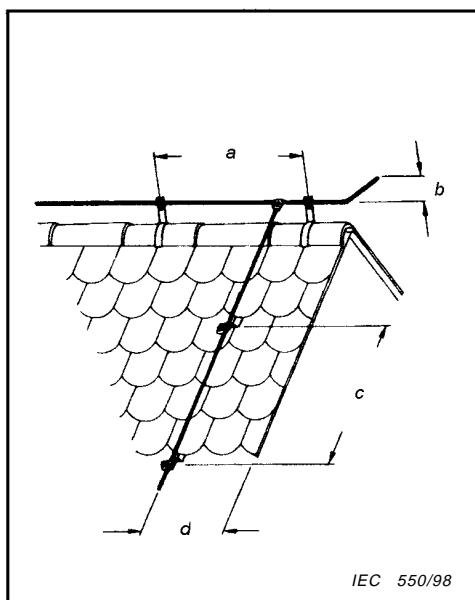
Installation d'un conducteur de capture sur la bordure d'un toit en pente et d'un conducteur de descente
